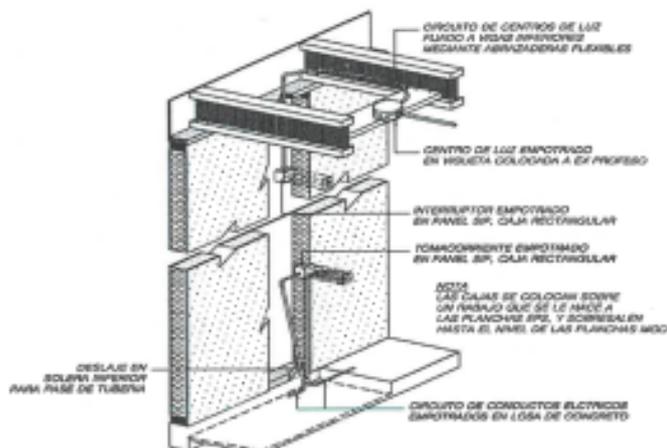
Detalle de incorporación de instalaciones eléctricas
